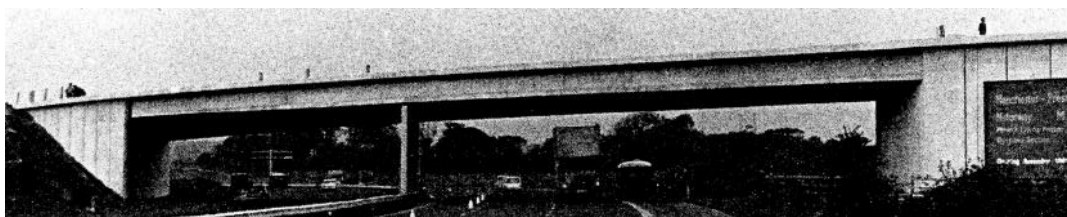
Ponte Blacow, Lancashire – Reino Unido (Drake, J. 1969).
